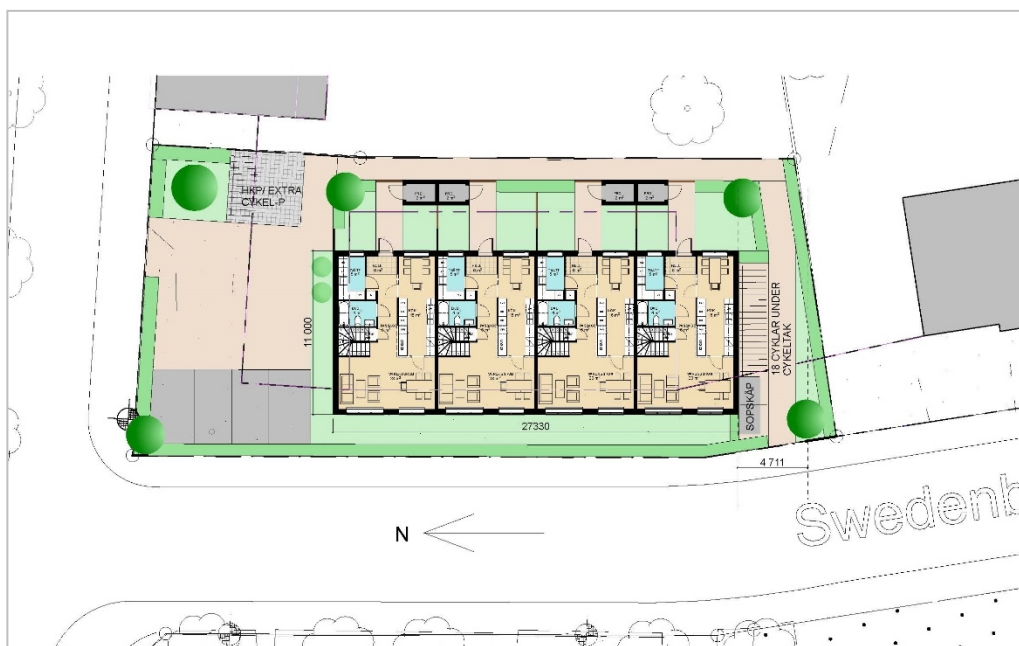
Illustrationsplan över planområdet som visar den föreslagna radhusbyggnaden. *Illustration: Tengbom arkitekter
